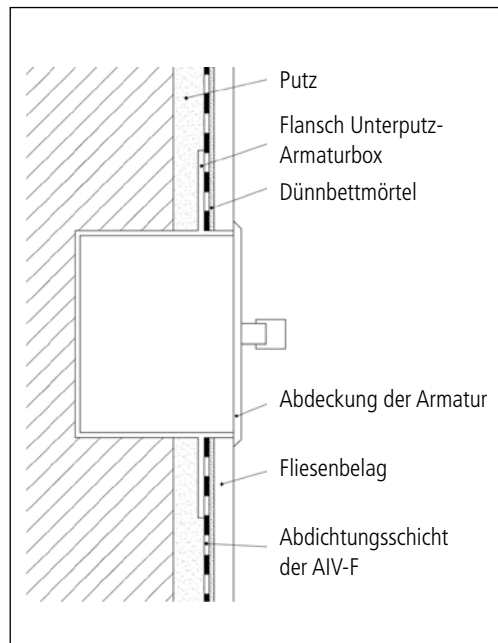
■ Anschluss einer Installationsbox an eine Verbundabdichtung (DIN 18534 [3])
